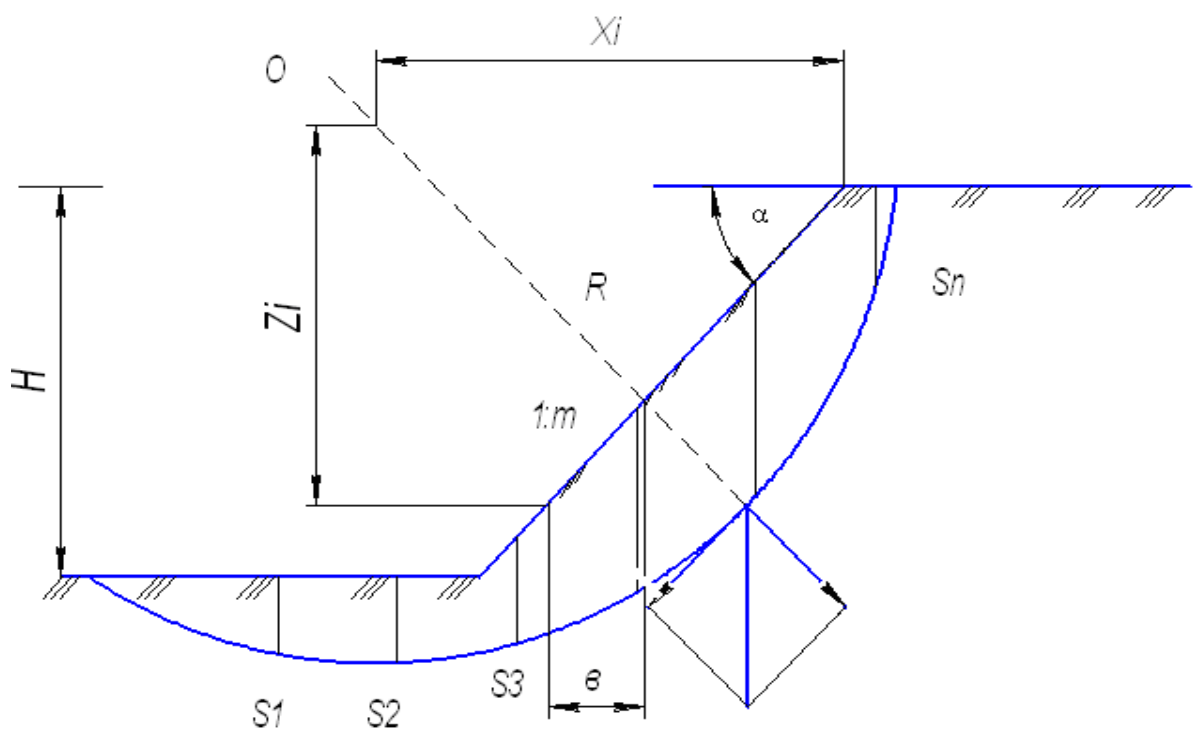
, 9. 1 – Розрахункова схема схилу.
